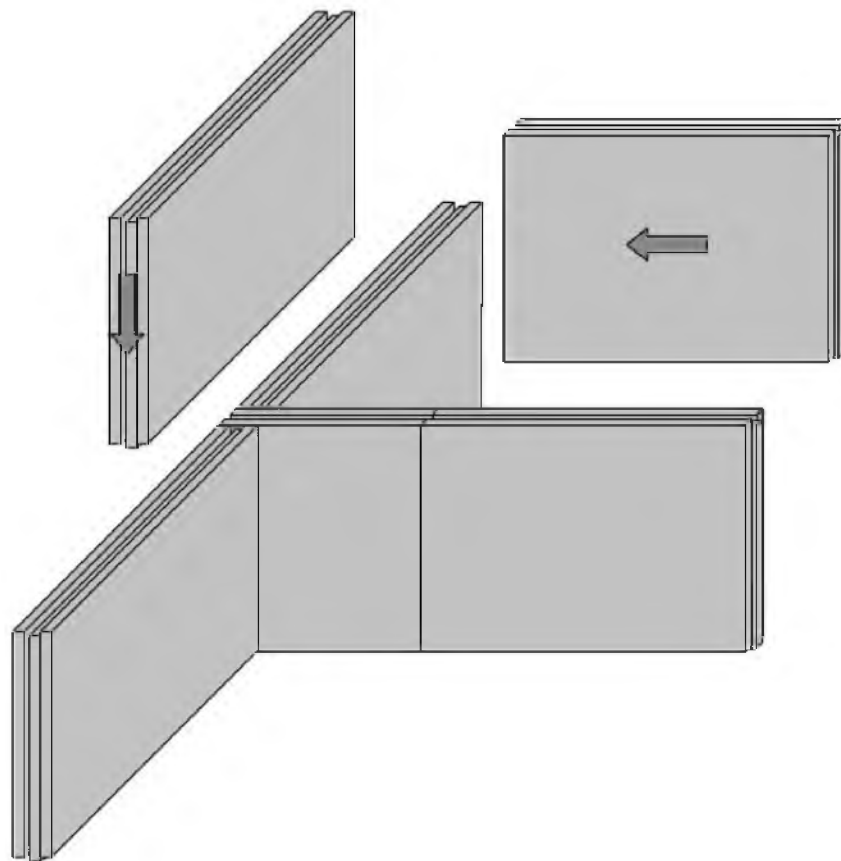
Монтаж плит при пересечении перегородок друг с другом.
